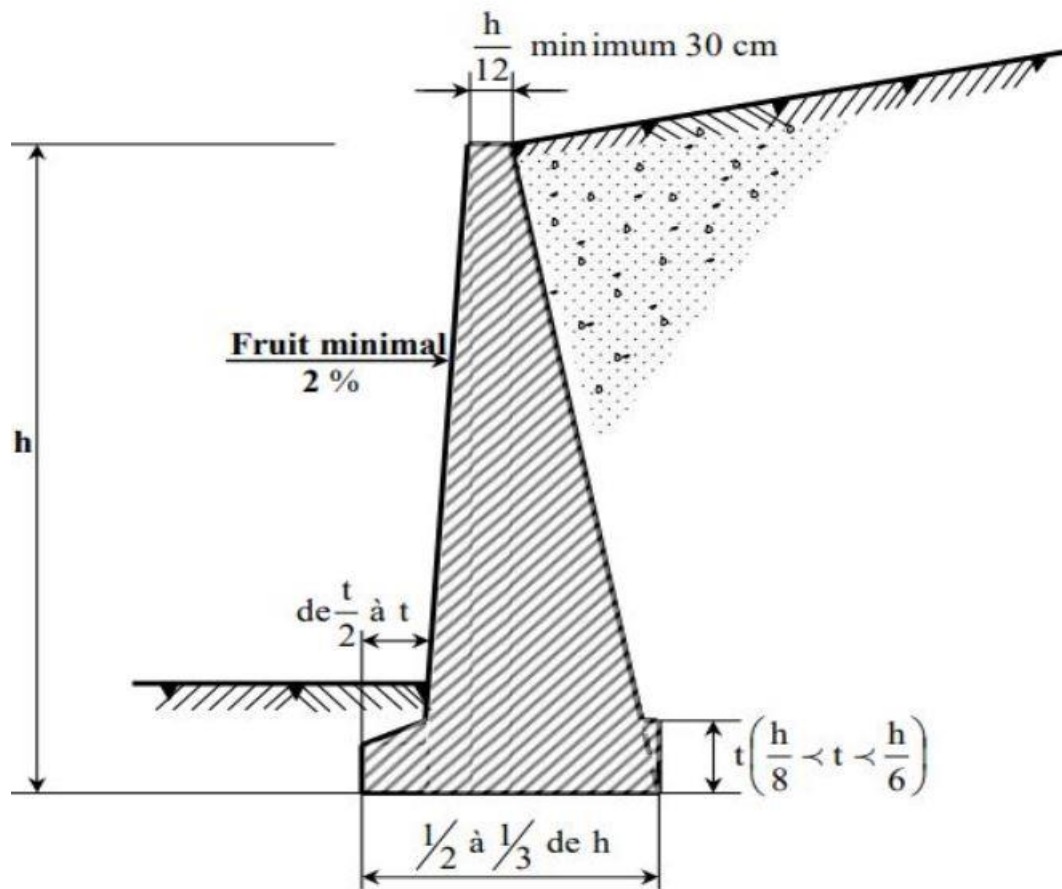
Dimensions usuelles d'un mur de soutènement en béton armé.
